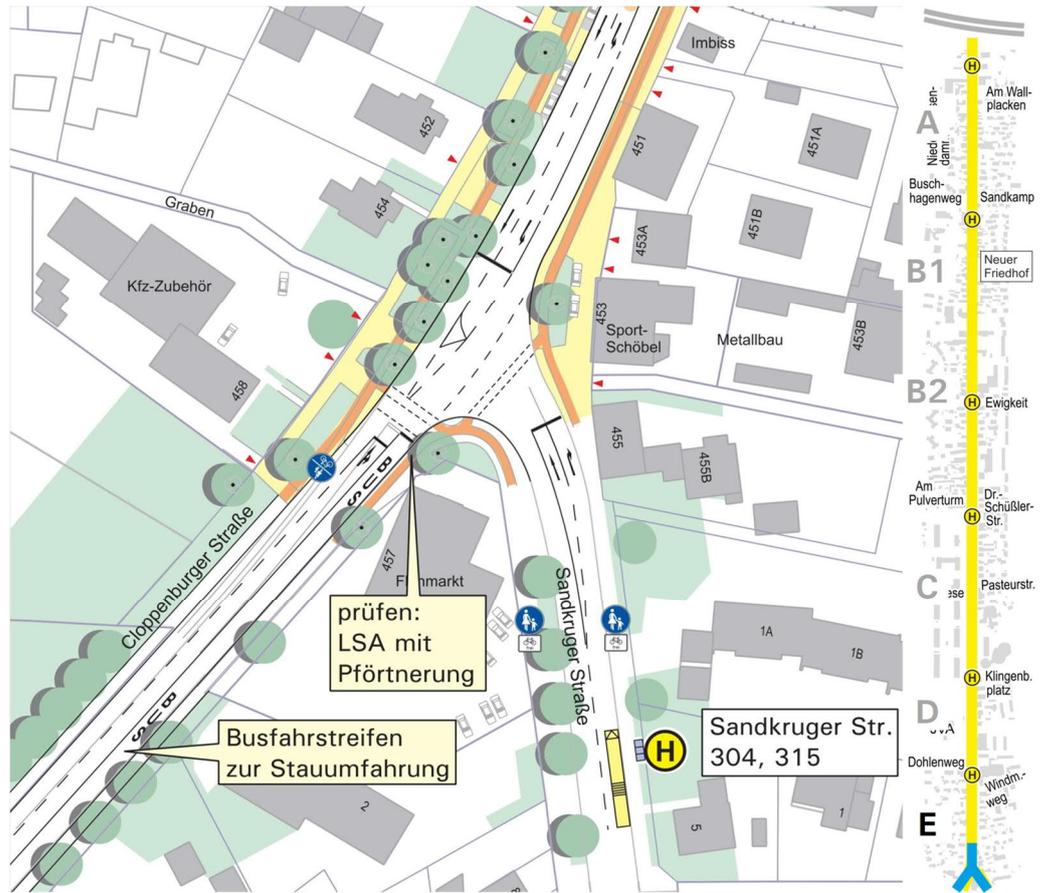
Knotenpunkt Cloppenburg Straße/Sandkruger Straße – Gestaltungsvorschlag mit Busfahrstreifen zur Stauraumumfahrung
